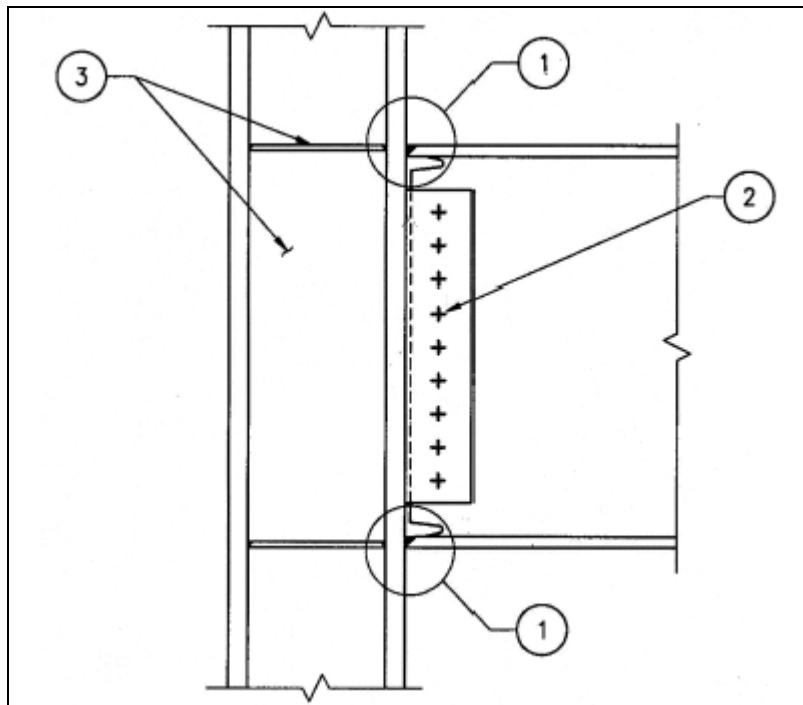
( Detallado de soldadura, plancha de corte y rigidizadores )
